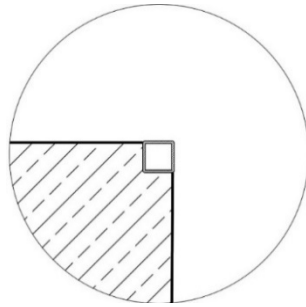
Profil równo „wtopiony” w krawędź elementu. Do profilu przyspawane marki z drutu stalowego w celu pewnego zakotwienia w betonie
